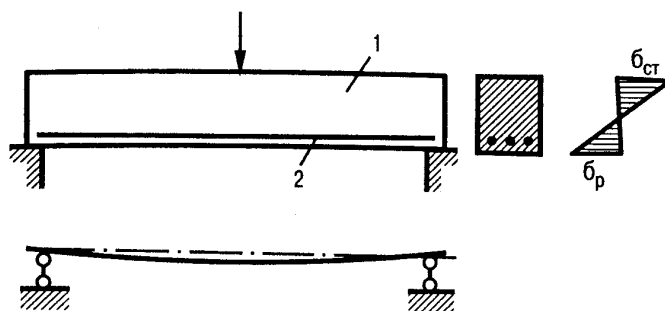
Схема роботи арматури в залізобетонній конструкції:
